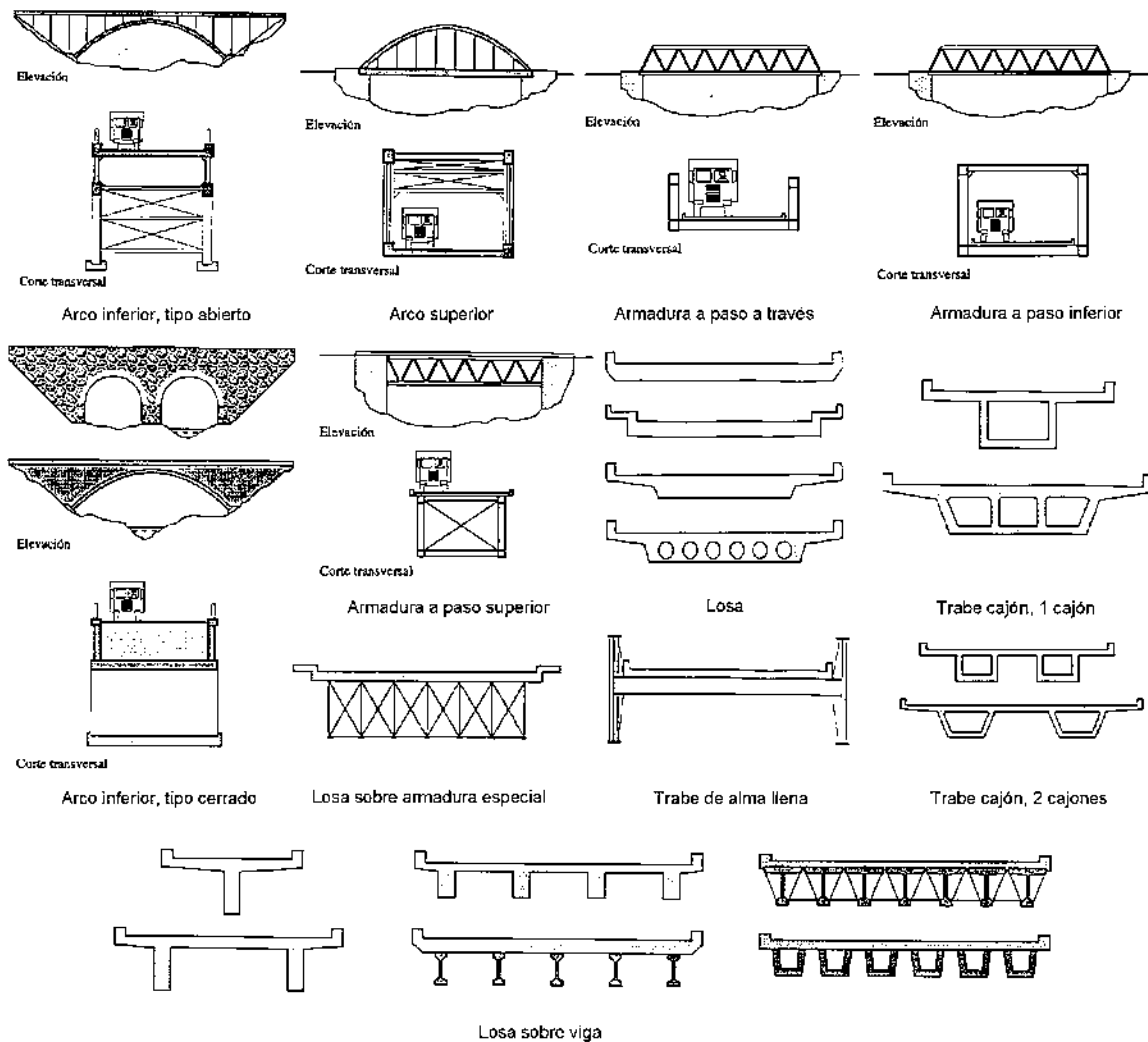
Tipos de sección transversal en puentes (SIPUMEX, 2013).
